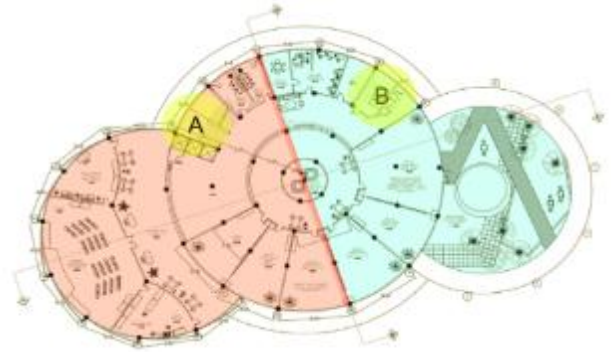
Sistem struktur rangka konstruksi beton.
